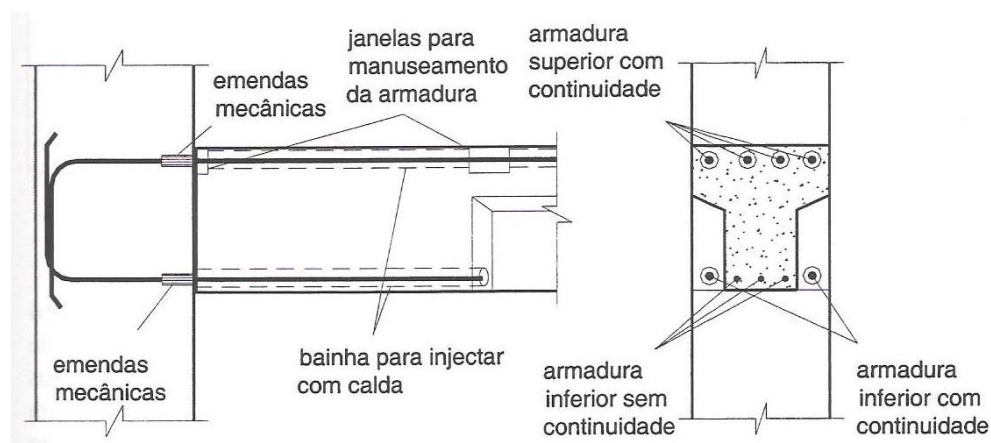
Ligação viga – pilar desenvolvida por Reis [22]
